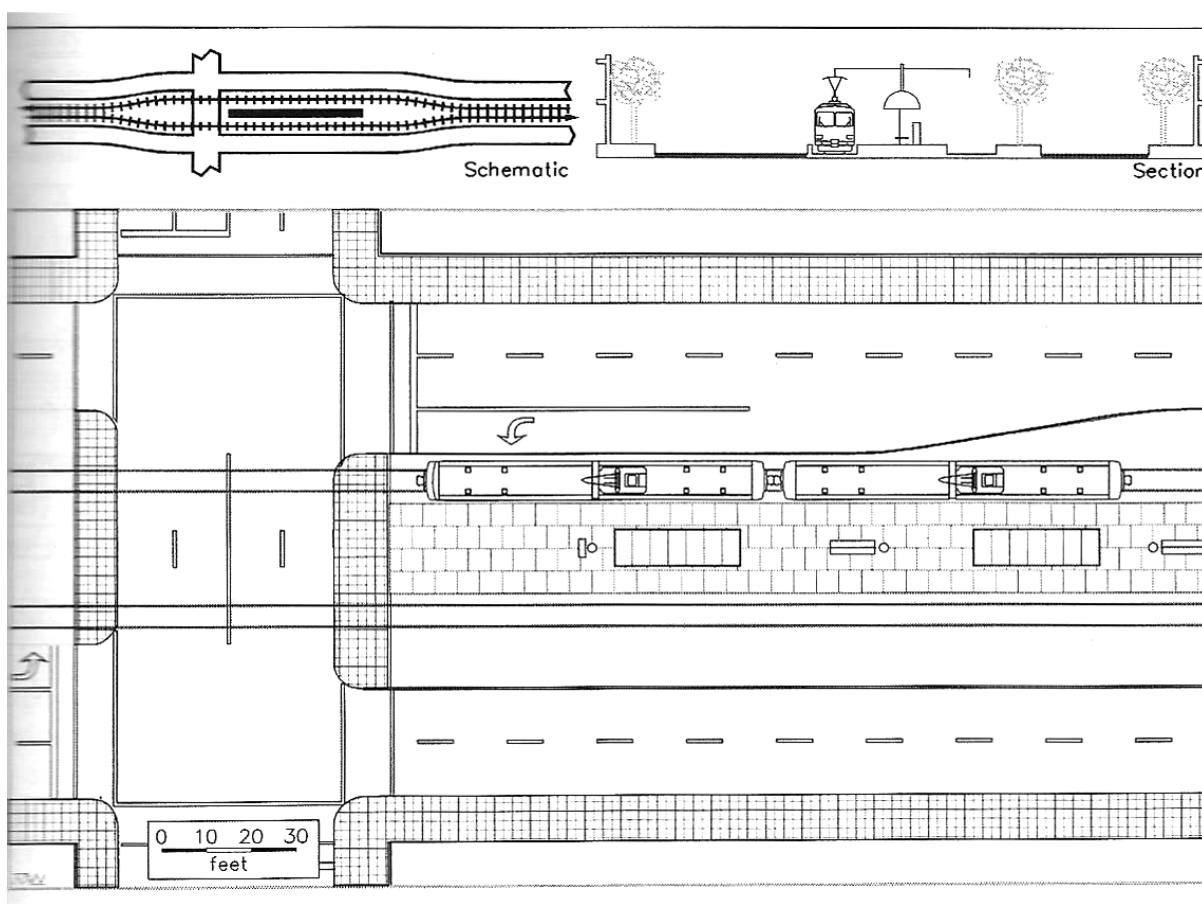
PLANTA DE PARADA NO CANTEIRO CENTRAL – FONTE: SIGURD GRAVA
